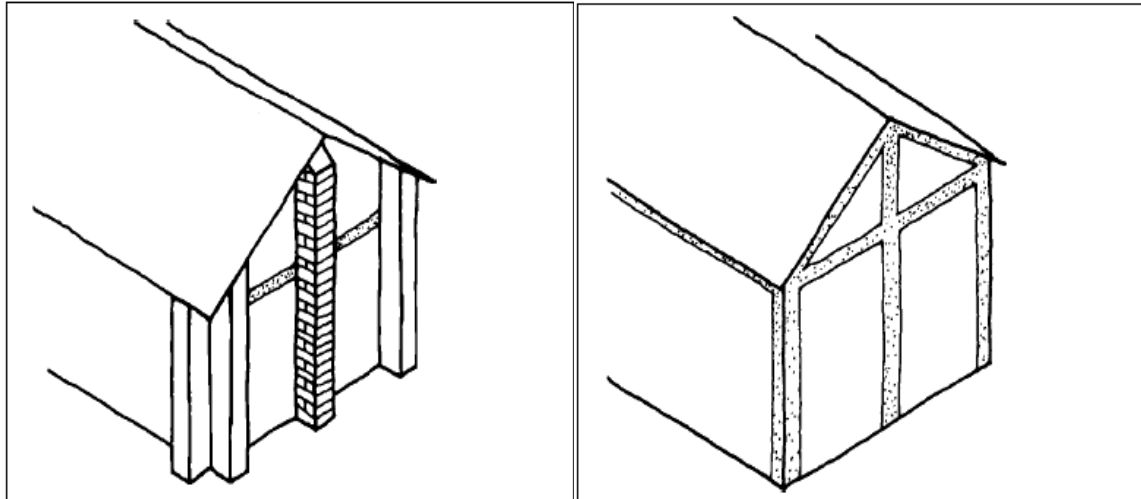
Tímpano estabilizado con contrafuertes Figura 3-44 Tímpano estabilizado con estructura de hormigón armado.
